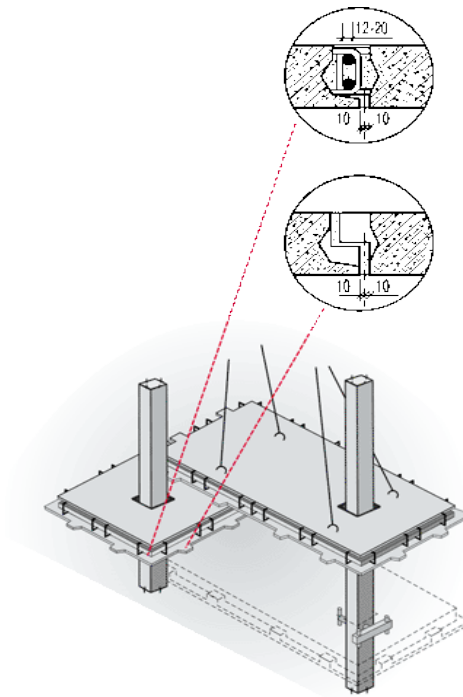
Вузли з'єднання колони з перекриттям, плит між собою
